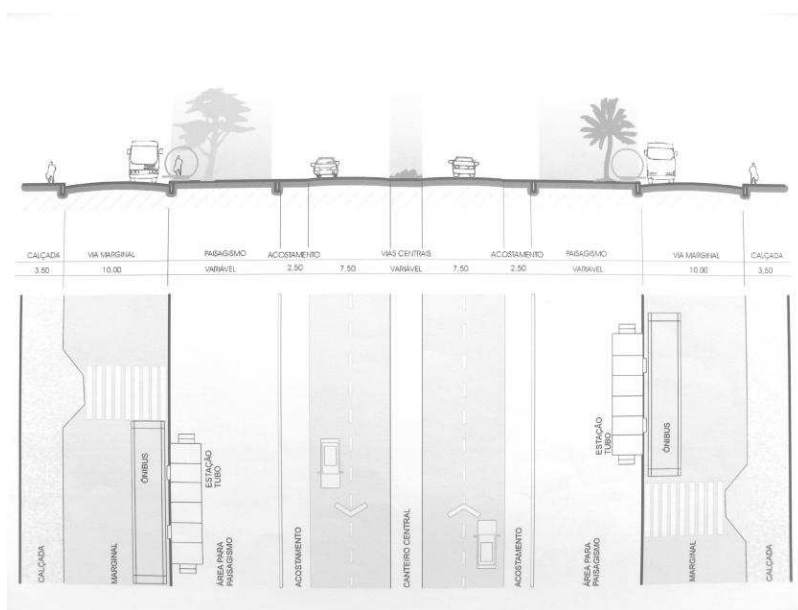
Corte e planta esquemática do Projeto BR-Cidade
